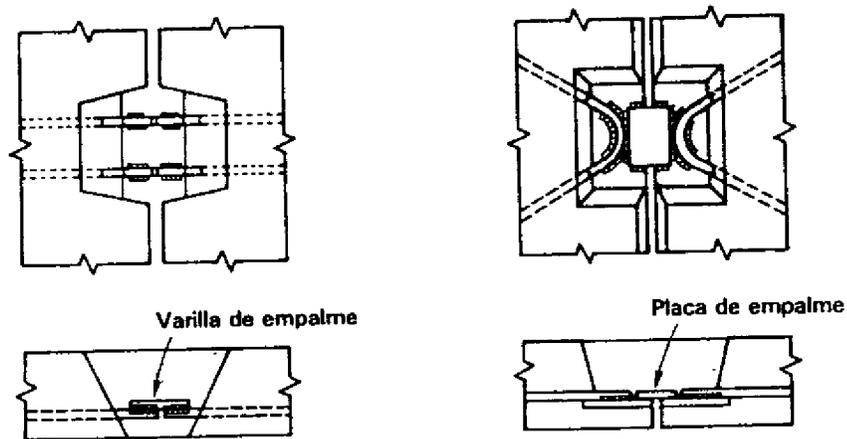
Junta en el sistema de piso (Wakabayashi, 1986).
